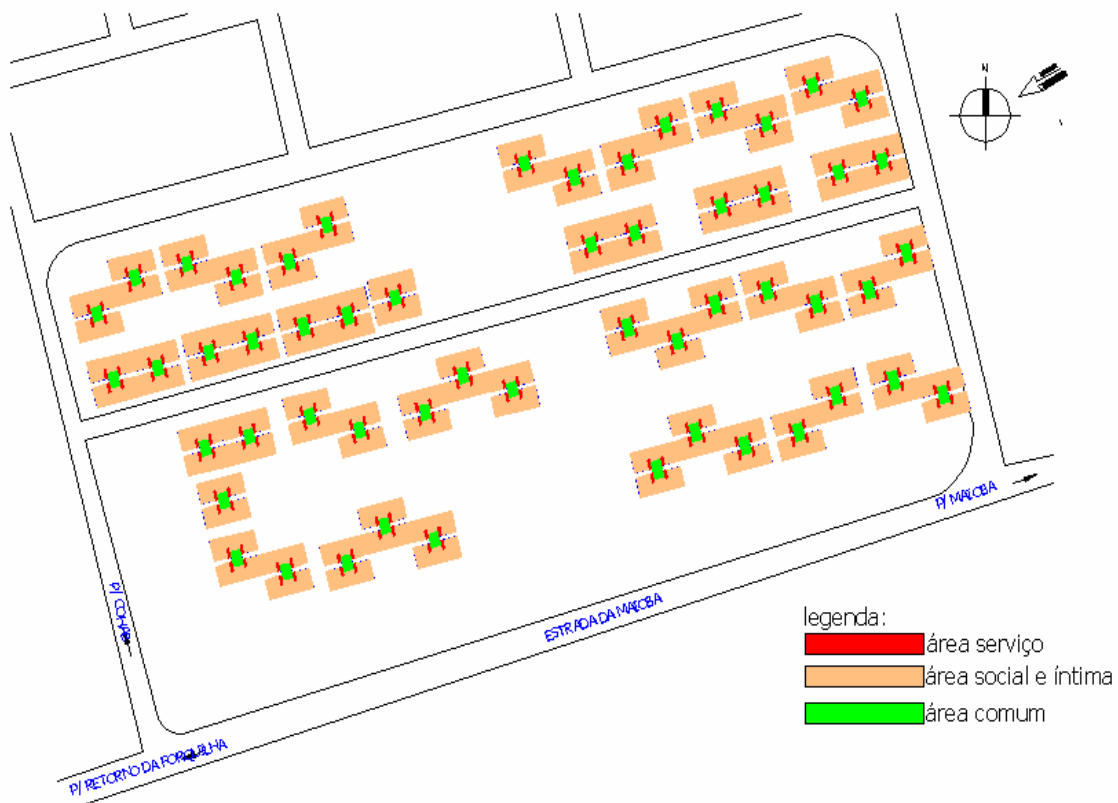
Planta de implantação ilustrativa do Conjunto Manacás
